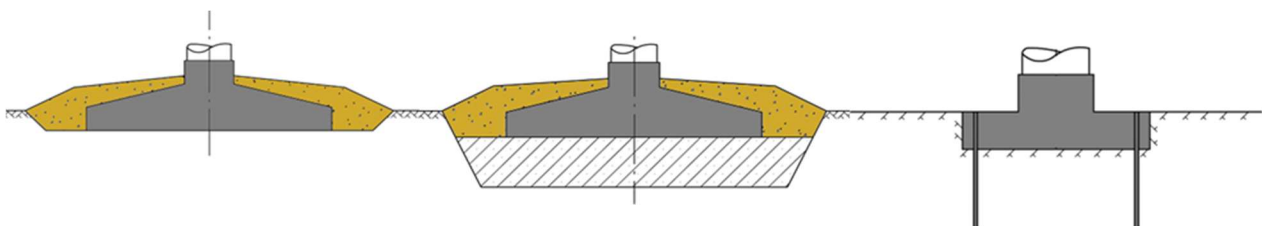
Principbilder över en grund av armerad betong på mark (till vänster) eller på en grund av armerad betong med massabyte (i mitten) samt en bergsförankrad grund av armerad betong (till höger).
